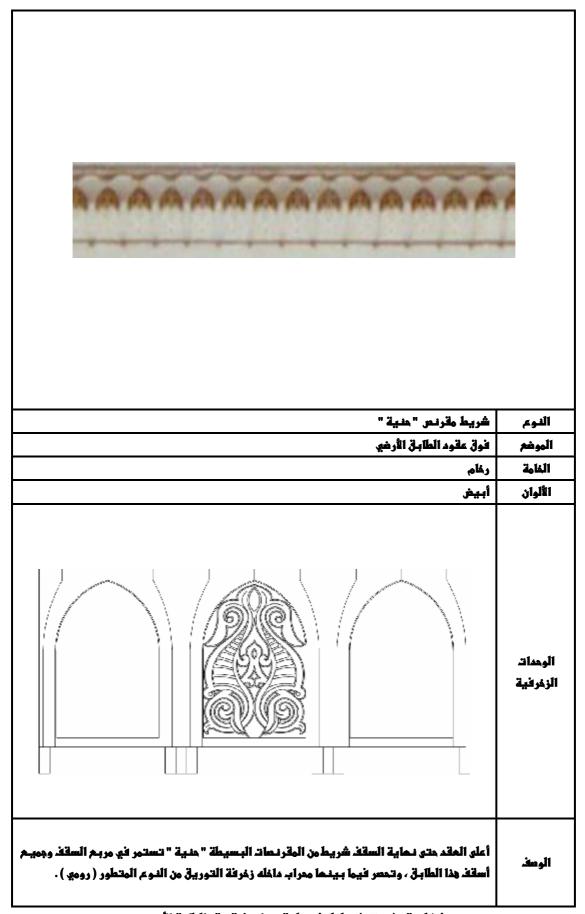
٥٣) تعليل عقد الطابق الأرضي
